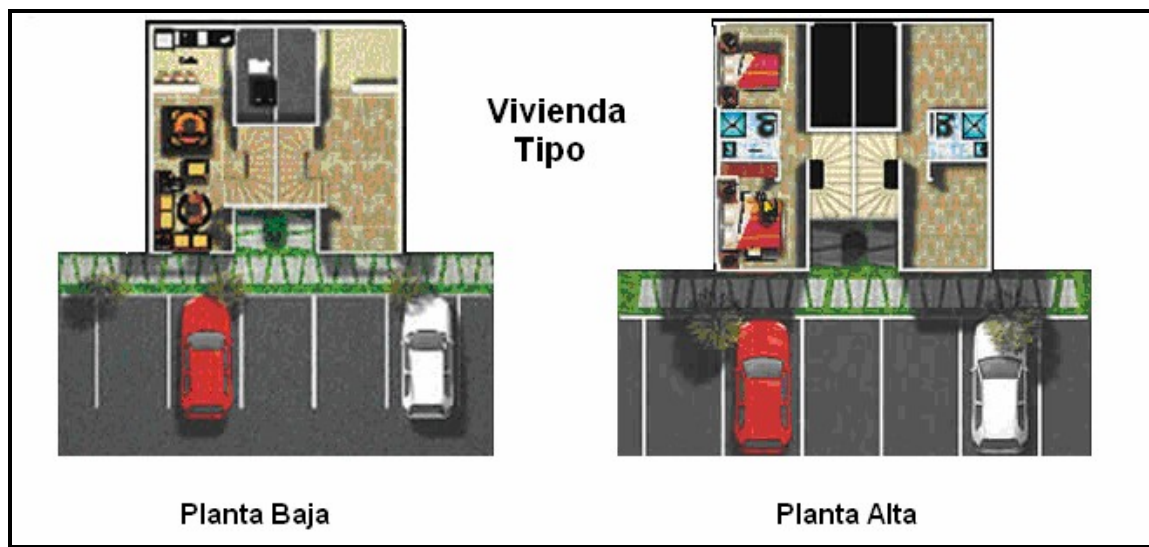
Vista Arquitectónica de la Vivienda Tipo.
